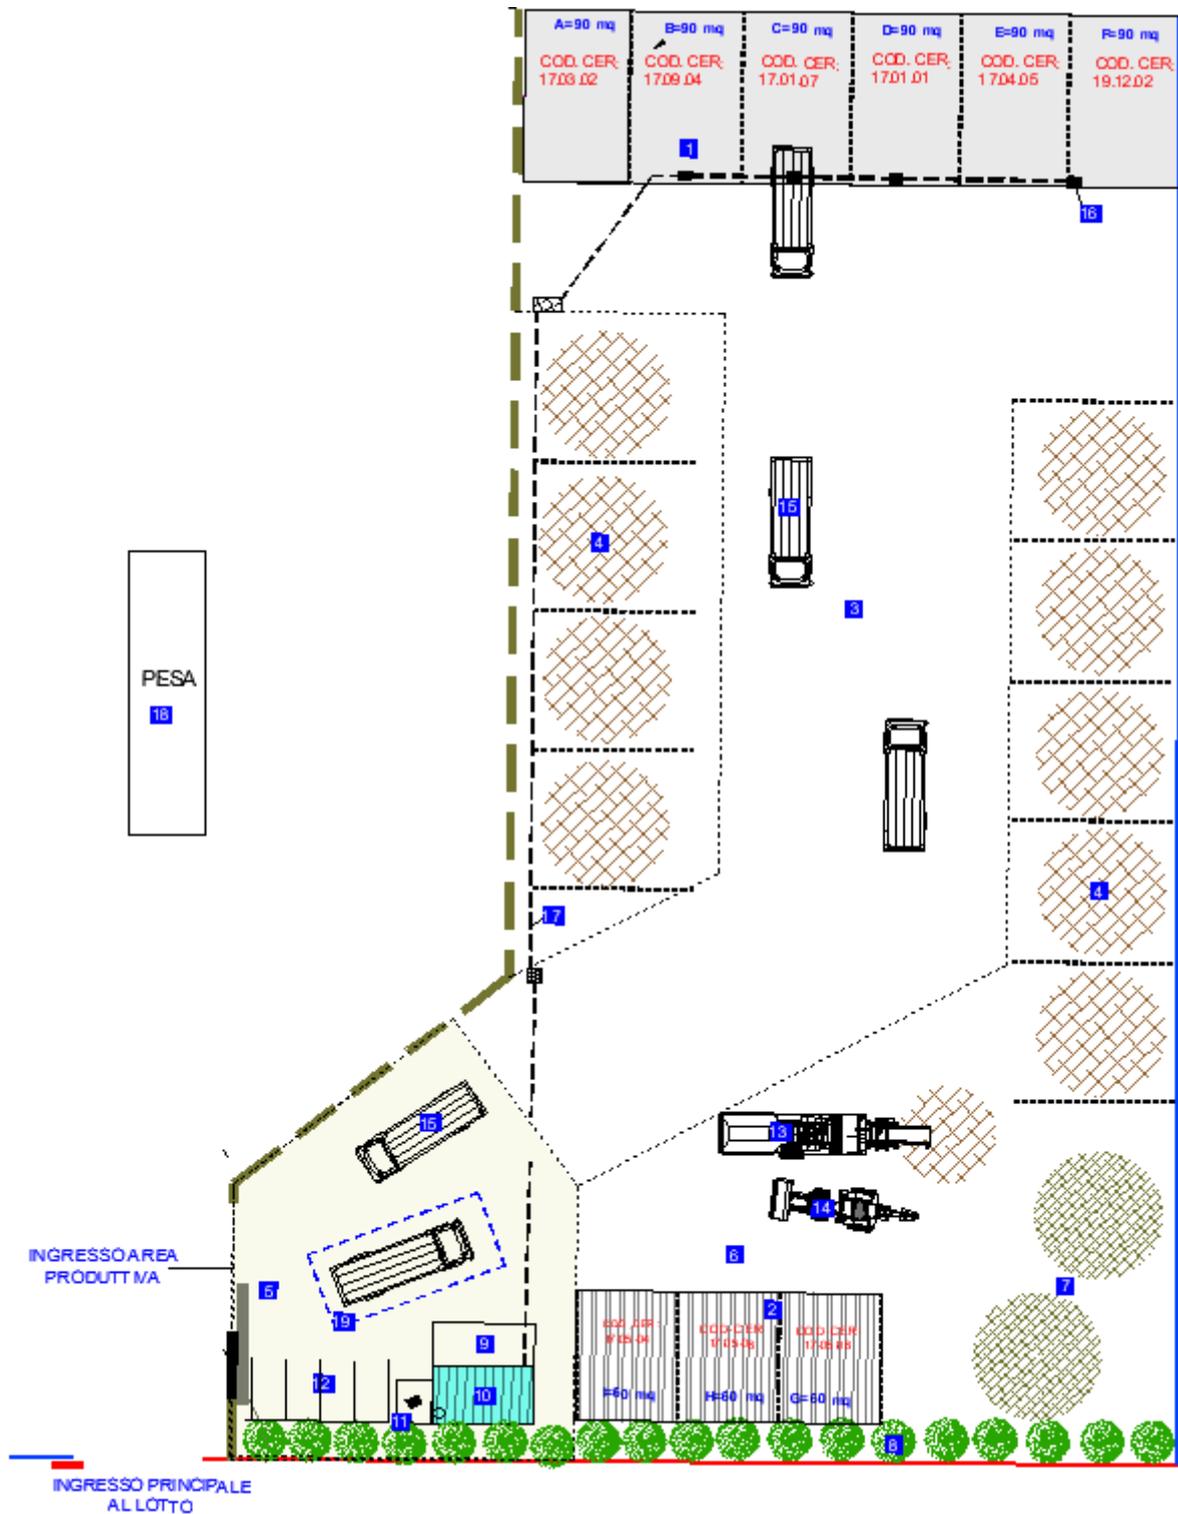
Pianta stabilimento produttivo già autorizzato in procedure semplificate dalla Città Metropolitana di Reggio Calabria Dlgs 152/2006 art. 214-216,; lay-out modificato per adattarlo alle nuove esigenze di progetto.
